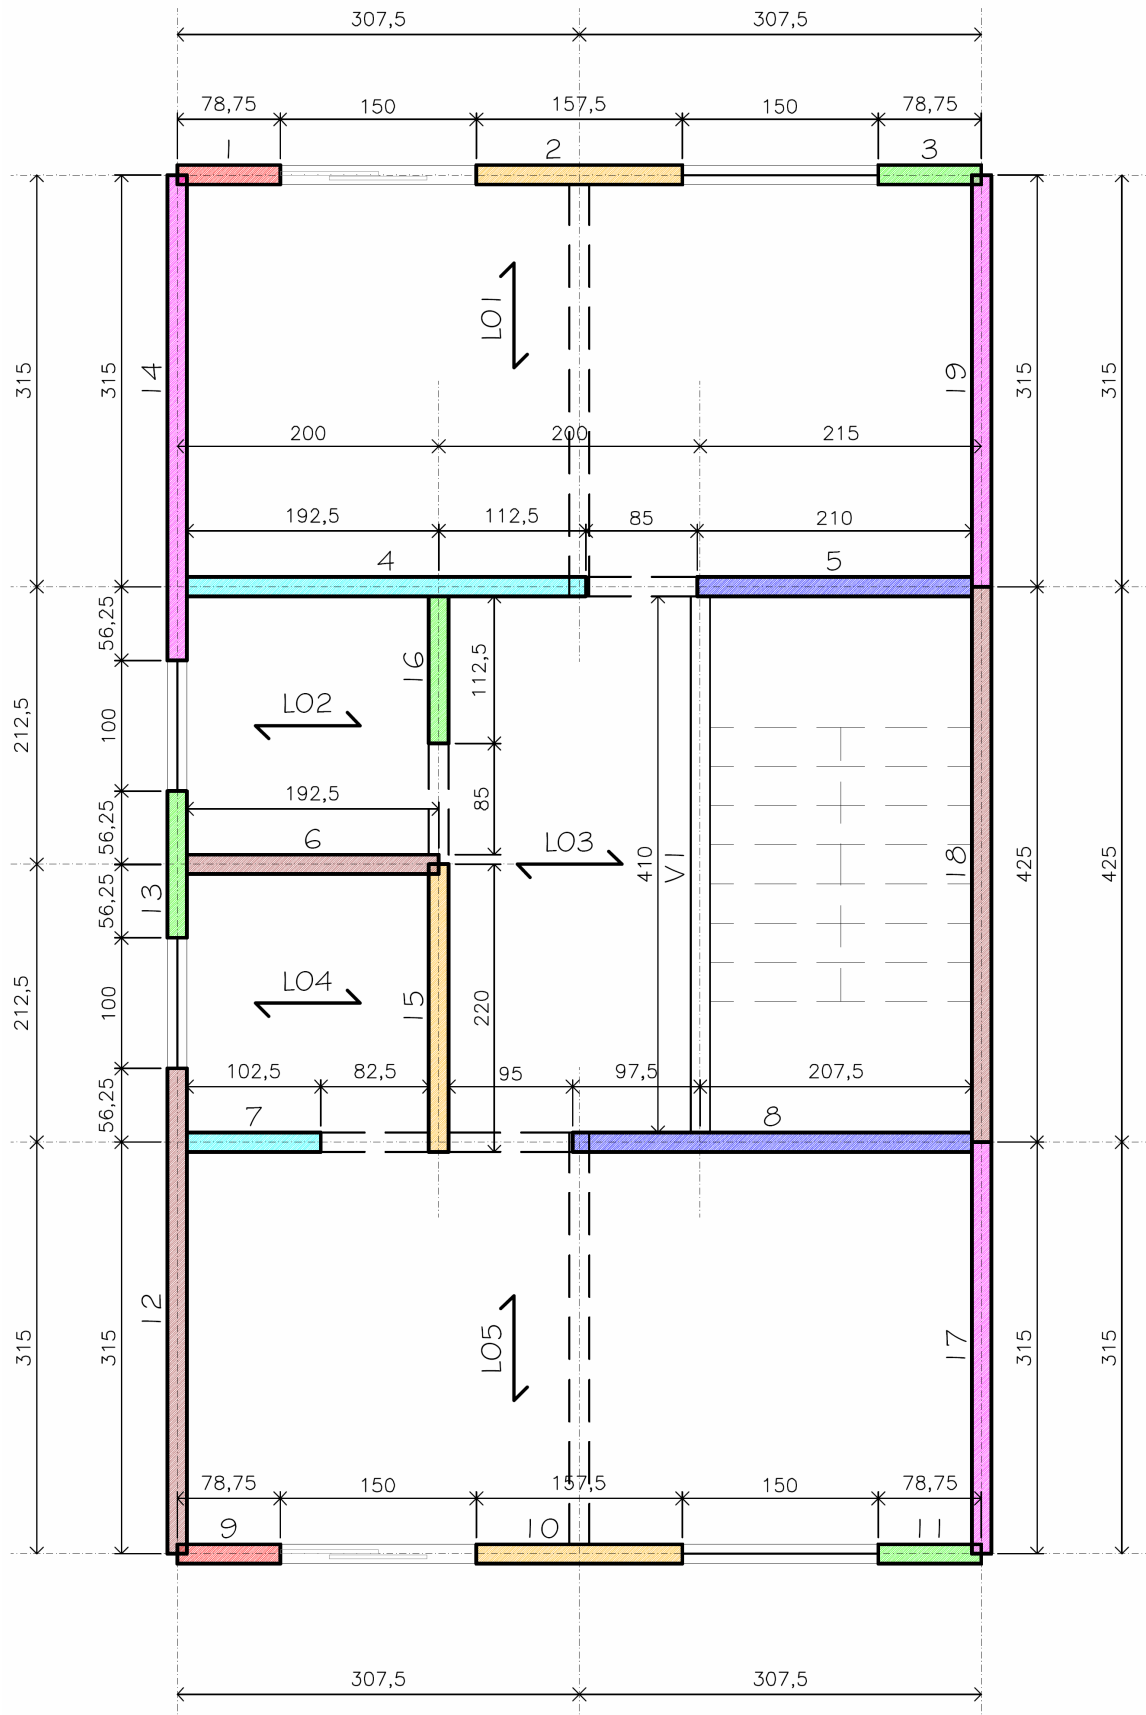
Estrutura do Exemplo K: pavimento inferior
